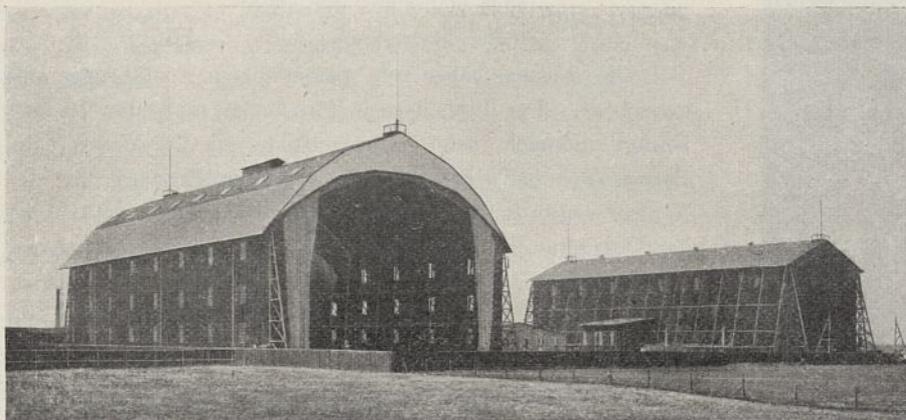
Zwei- und einschiffige Bauhalle in Holz.
